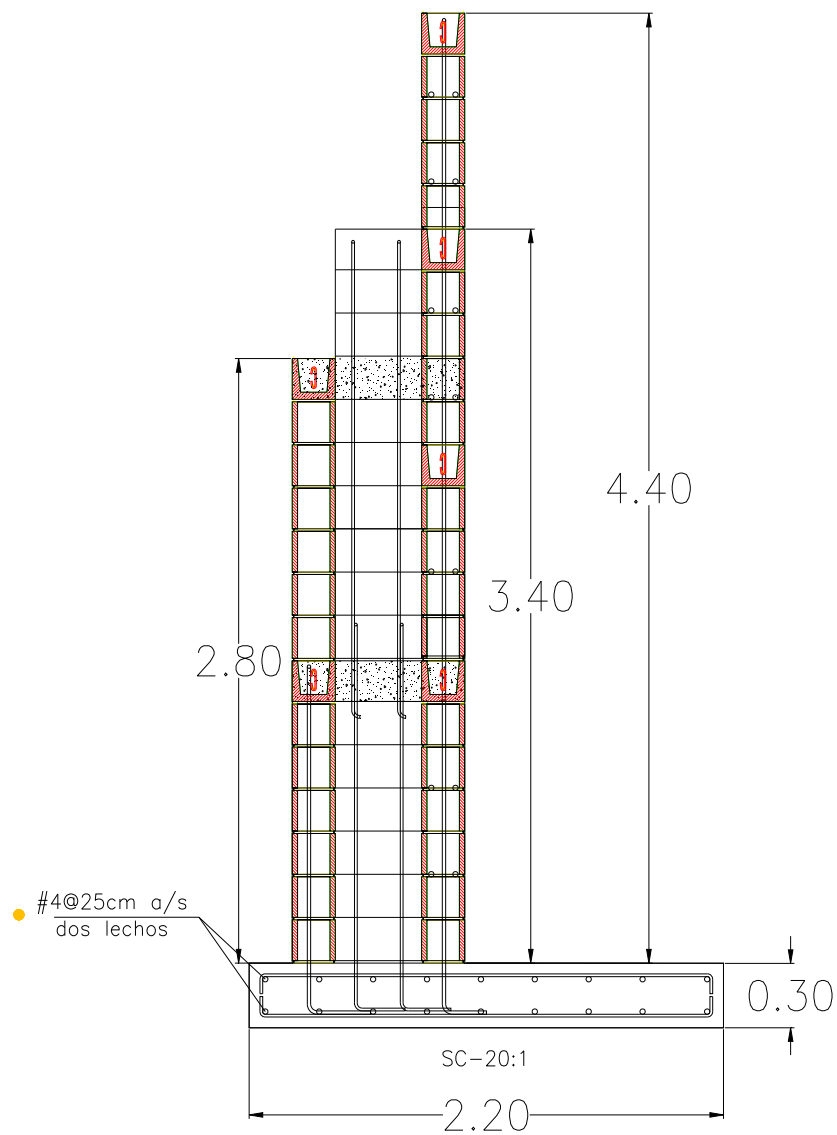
Sección transversal típica de muro a construir, diseño final aprobado y autorizado
